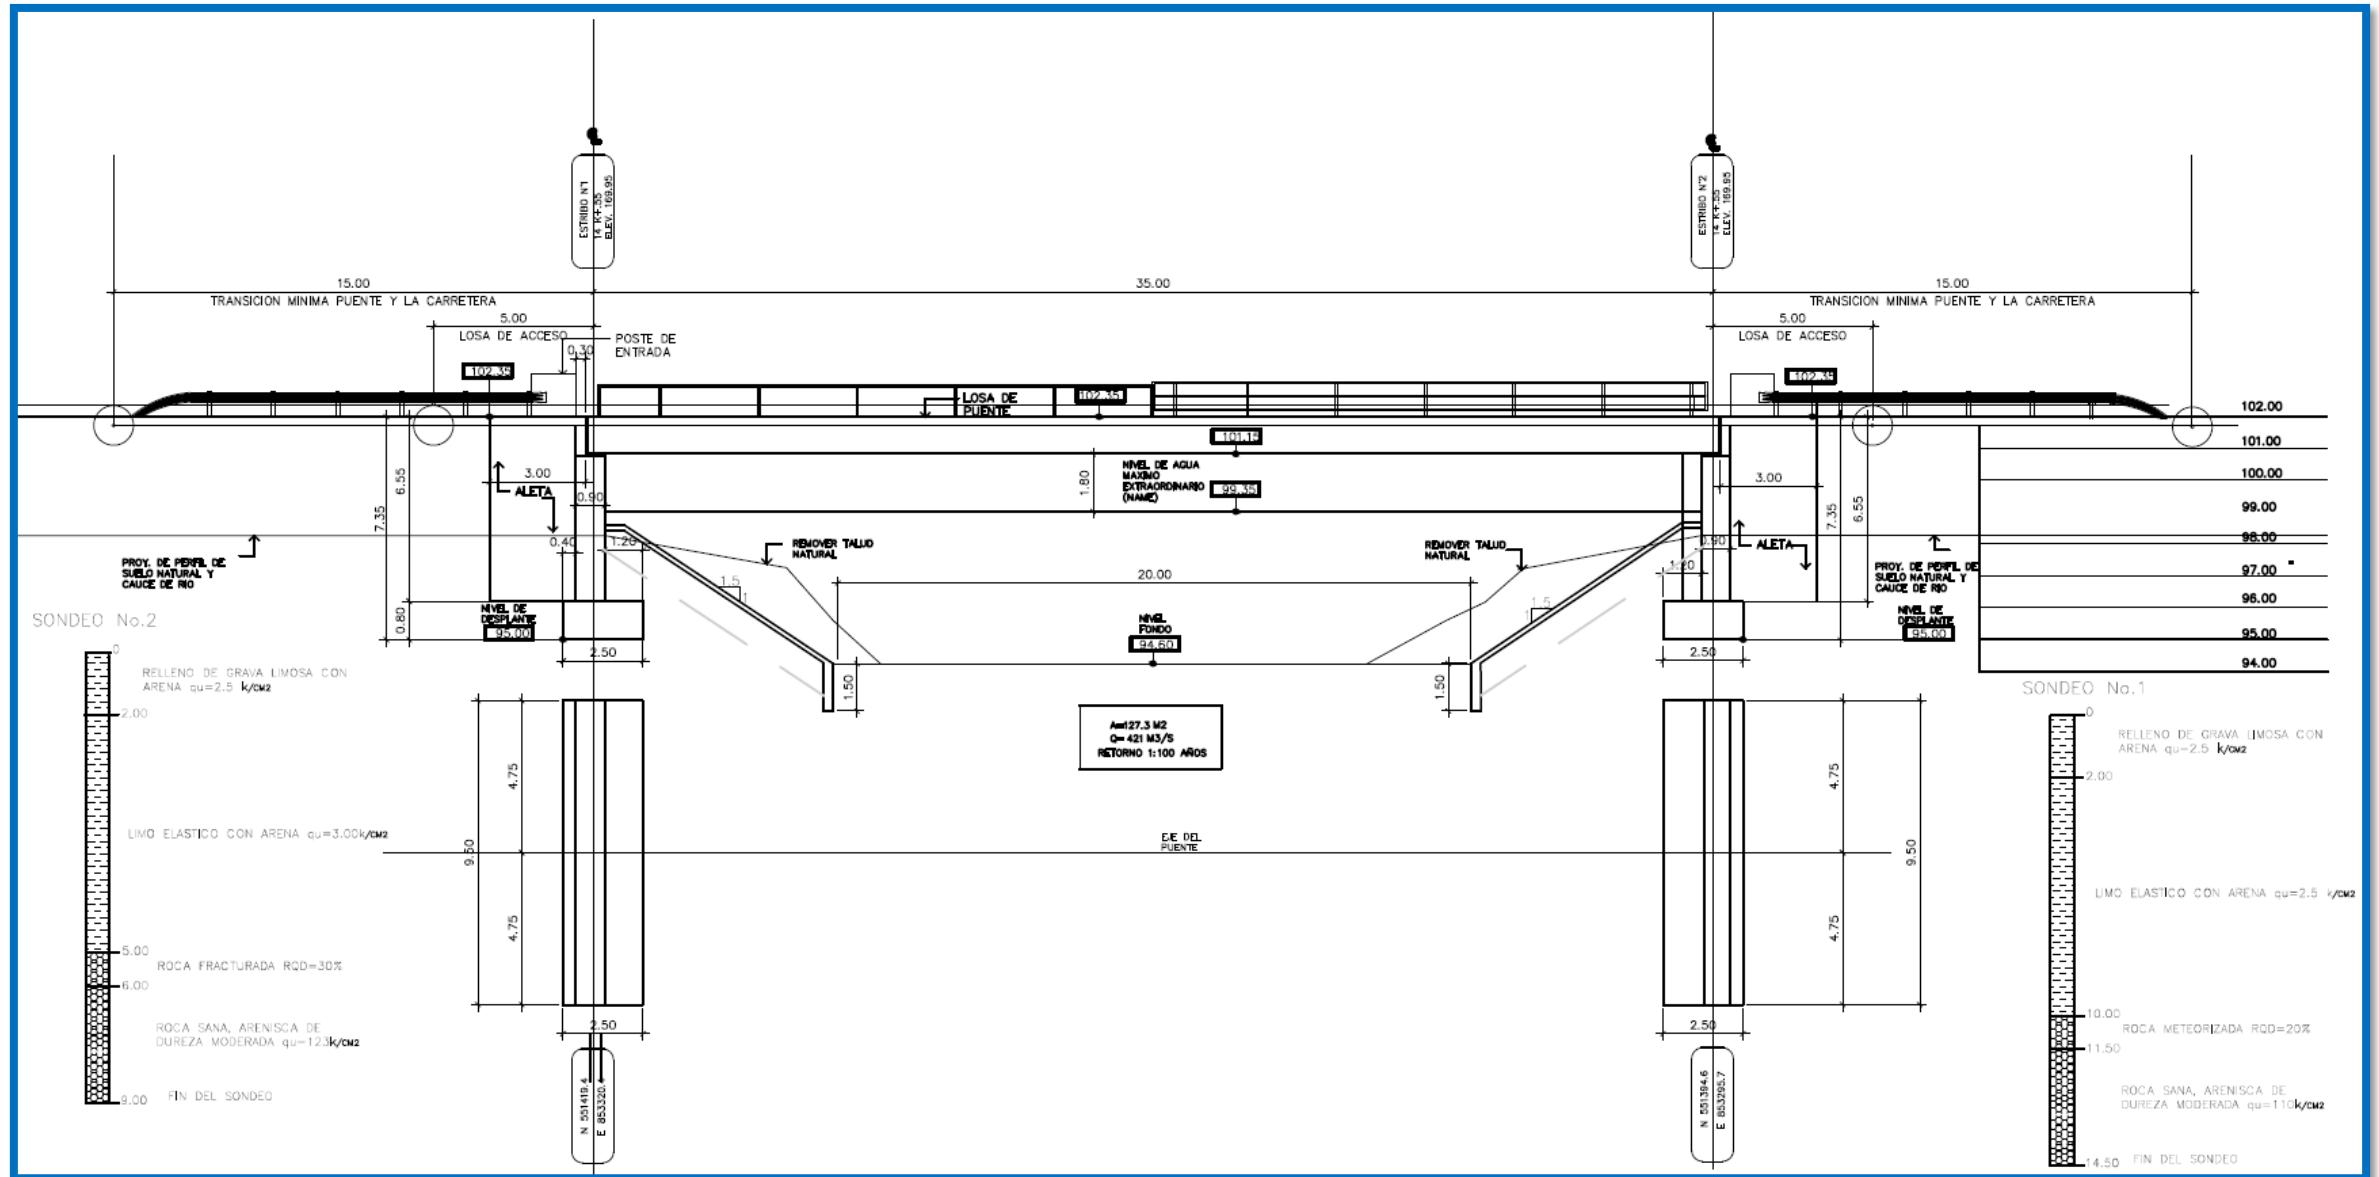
Diseño final con las dimensiones del puente y sección geométrica sobre el Río Cacao.
